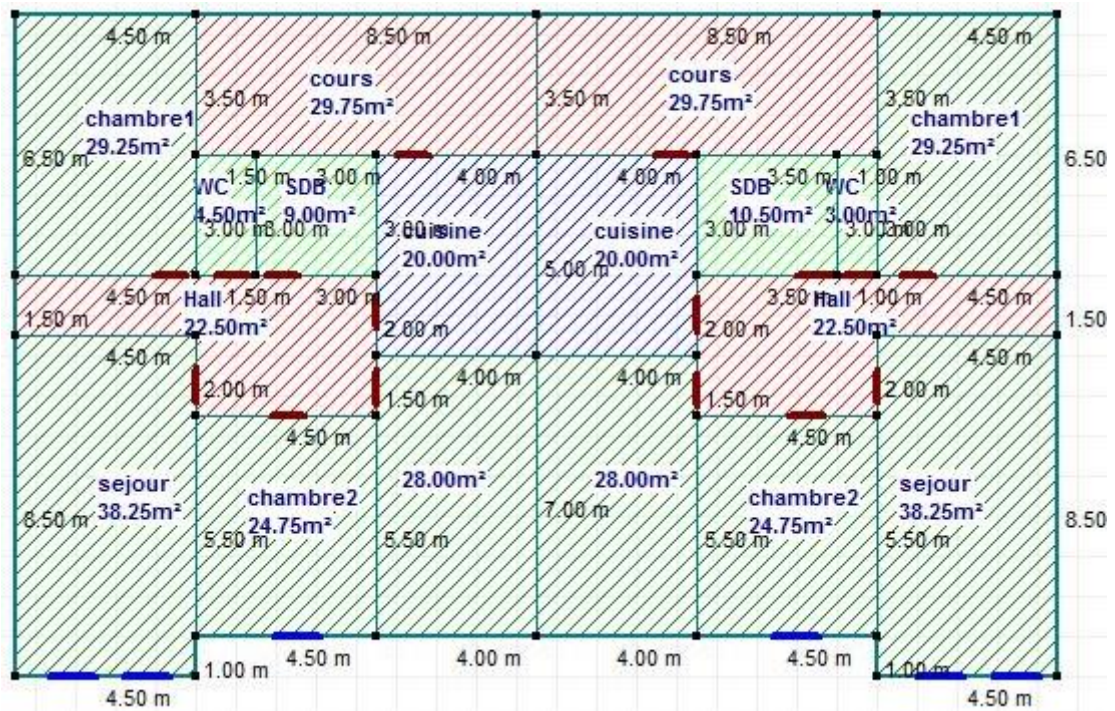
plan de RDC (Mostaganem) sur alcyone
